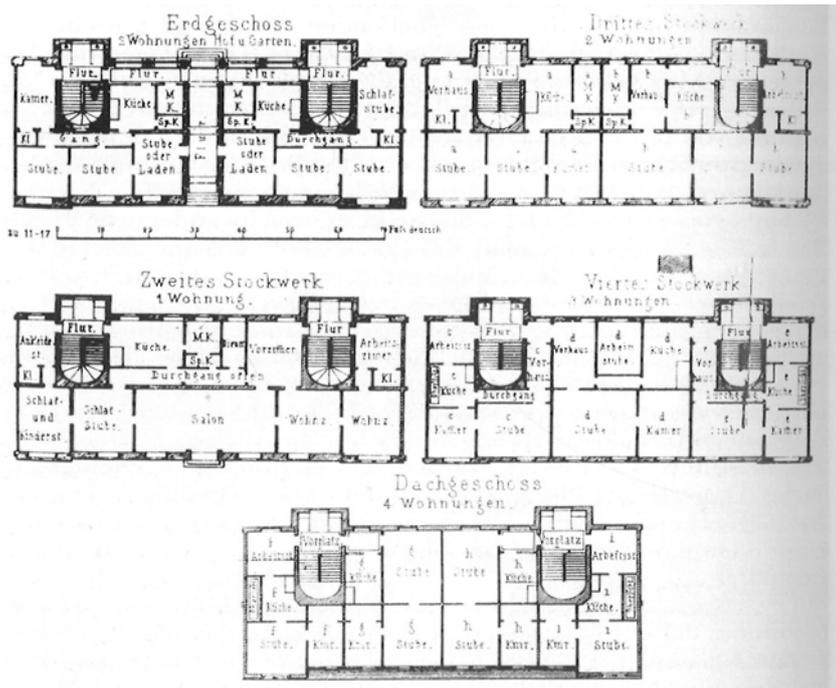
Mustermietshaus 1865, Grundrisse
